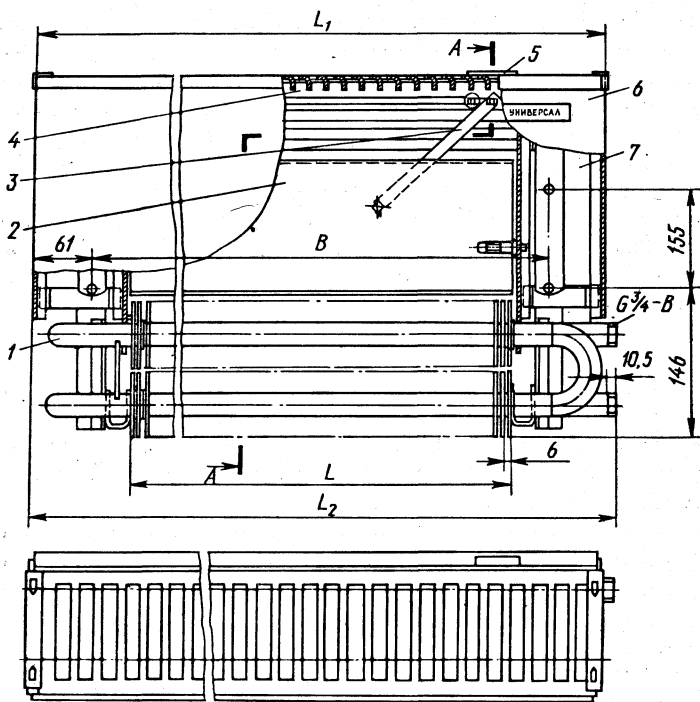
Стальные настенные конвекторы с кожухом малой глубины «Универсал» (а) и средней глубины «Универсал С» (б): 1 — нагревательный элемент, 2 — регулирующий клапан, 3 — тяга, 4 — воздуховыпускная решетка, 5 — движок, 6 — кожух, 7 — кронштейн
